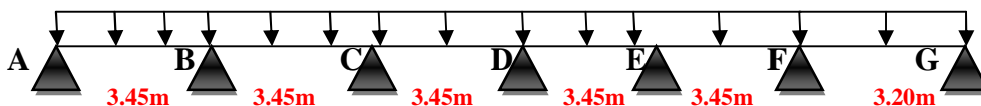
Schéma statique de la poutrelle T1 (Terrasse inaccessible)
